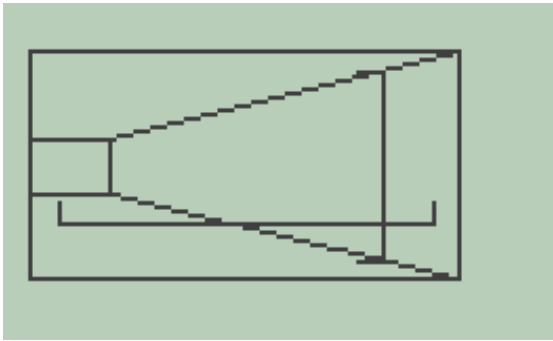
Sapata em divisa - Detalhamento das armaduras.
